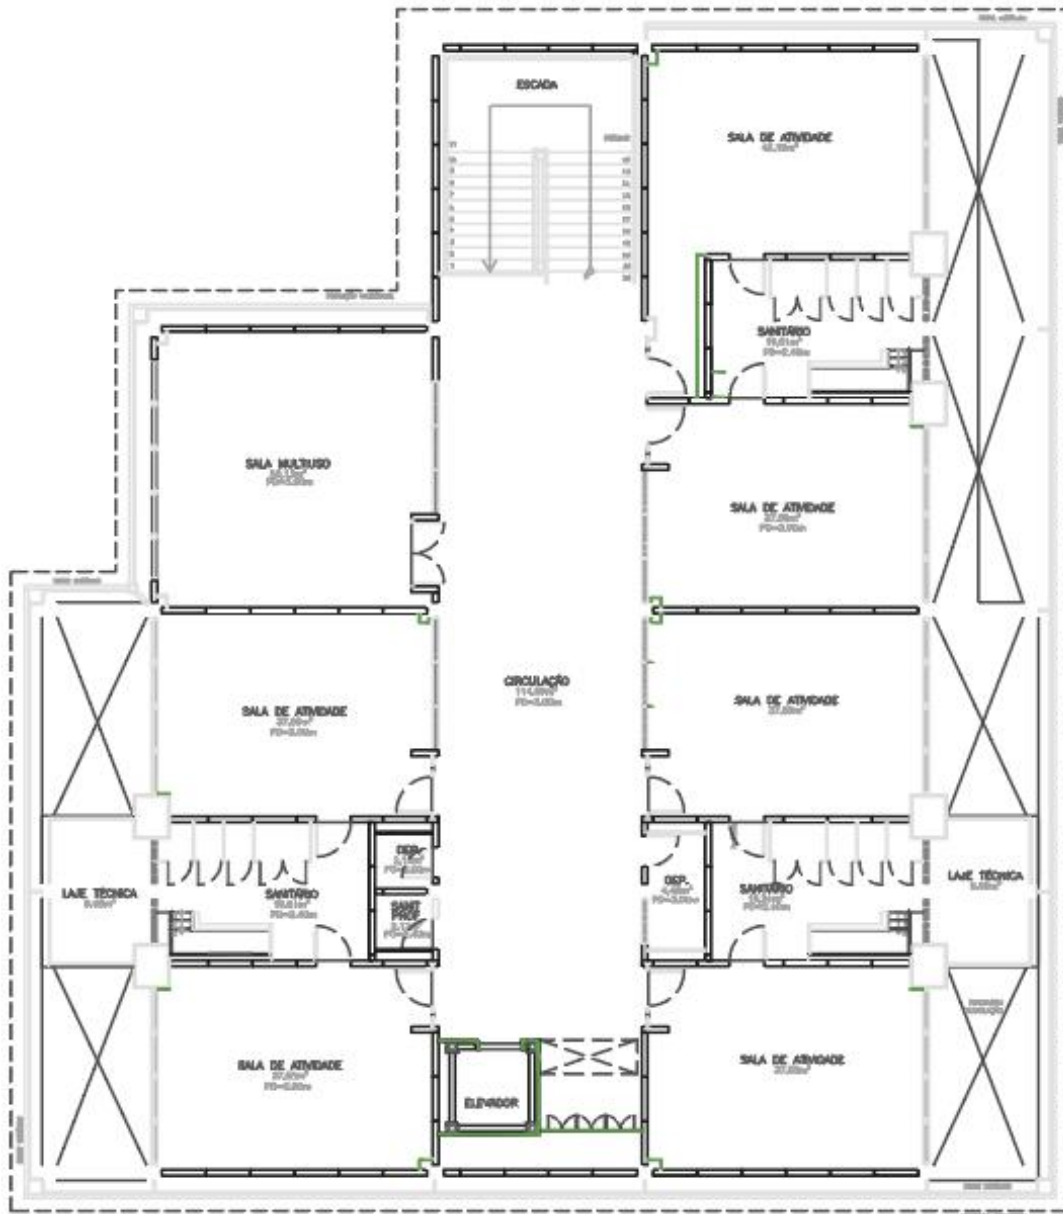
Planta 2ª de um projeto padrão de EDI das Escolas do Amanhã
